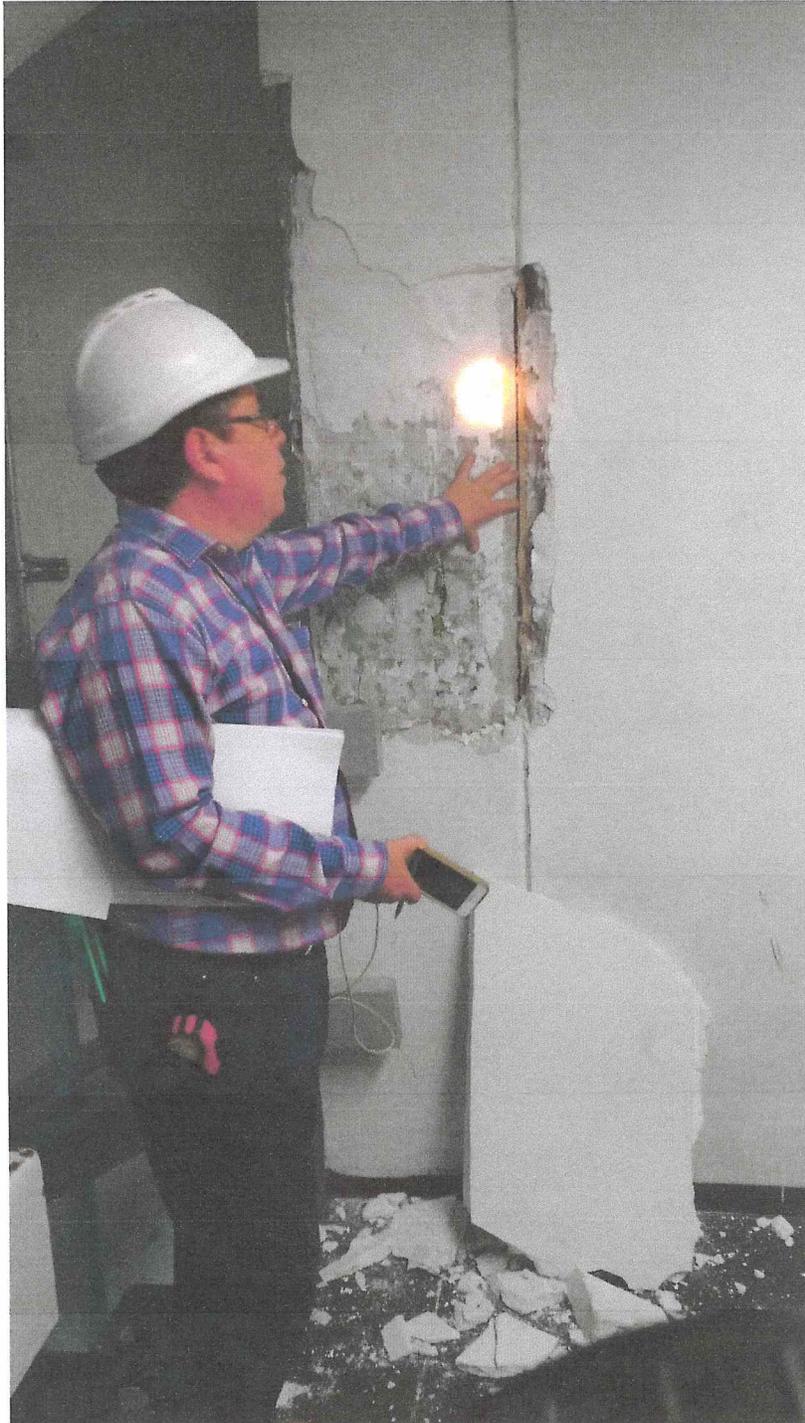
Separación del elemento estructural del muro de relleno, se precisa que los muros están desligados de las columnas.
